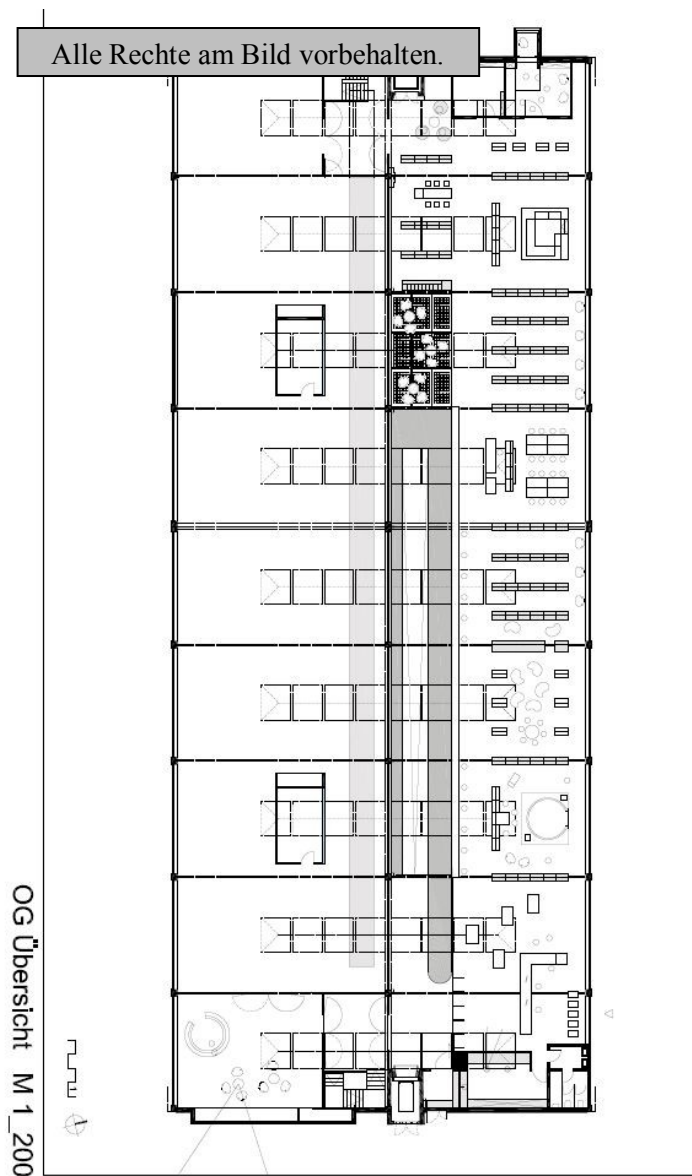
Pausa-Halle, Grundriss OG. © baldauf architekten gmbh.
